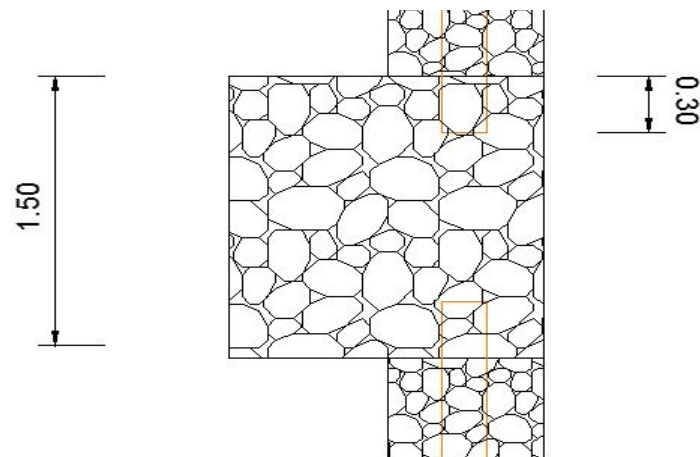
Penetrazione tubi in Pvc delle trincee nel pozzo drenante
